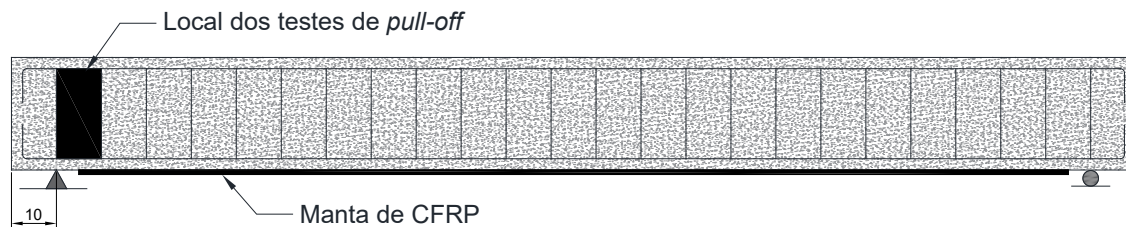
Região de aplicação do CFRP nas vigas de concreto armado reforçadas.
